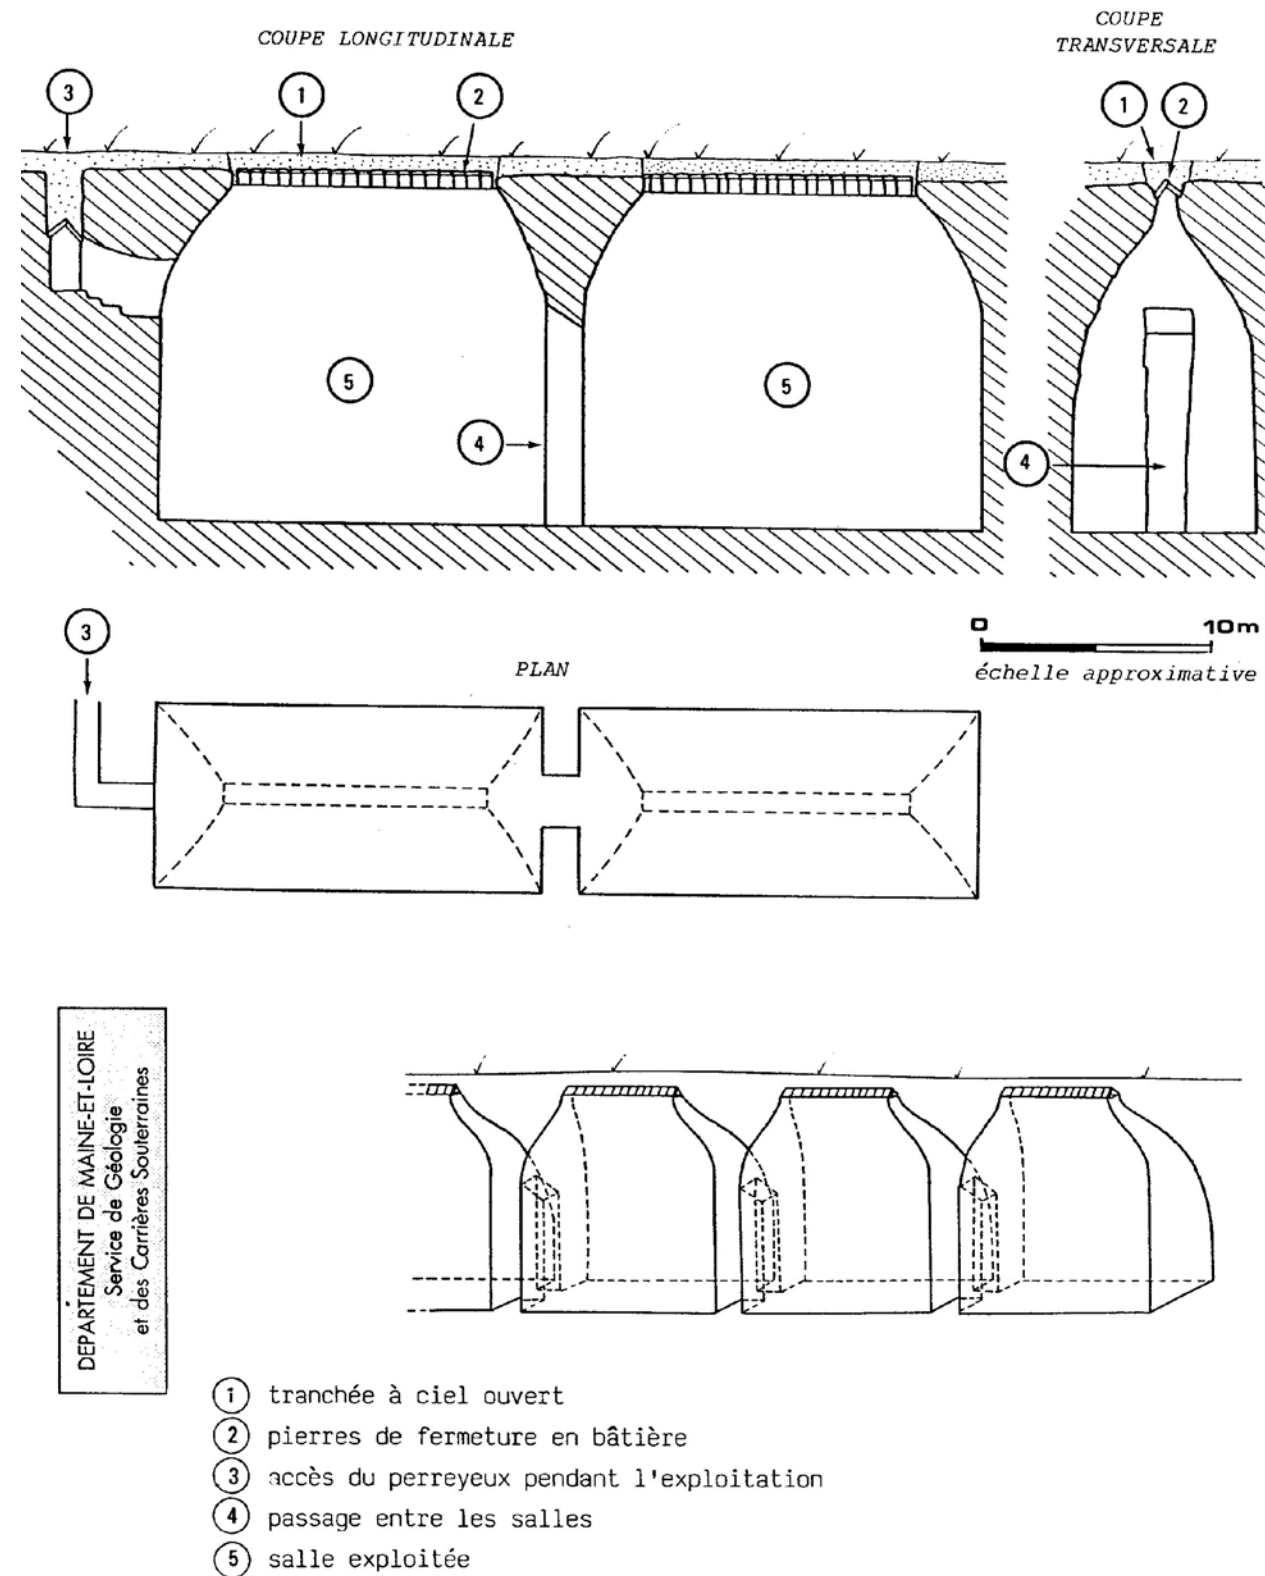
Coupes et plan d'une extraction souterraine dans le falun (Source SGCS 49)
